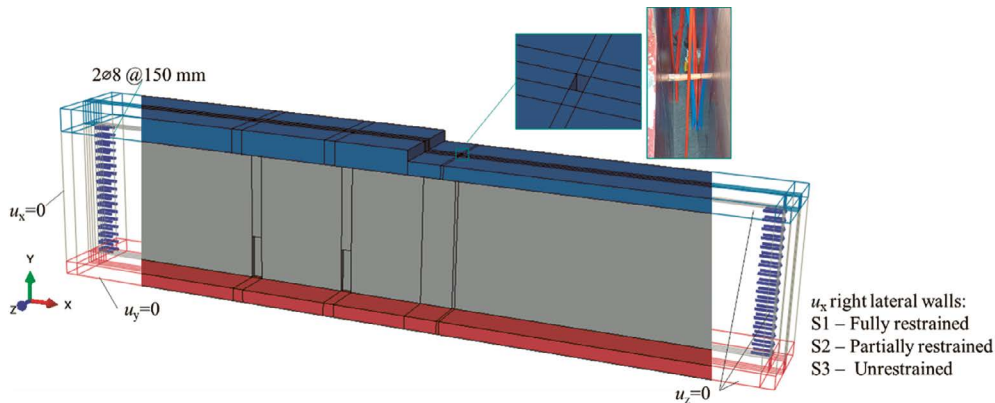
MEF para el muro de 13.0 m: cargas y condiciones de contorno, geometría detallada y configuración de armadura.
